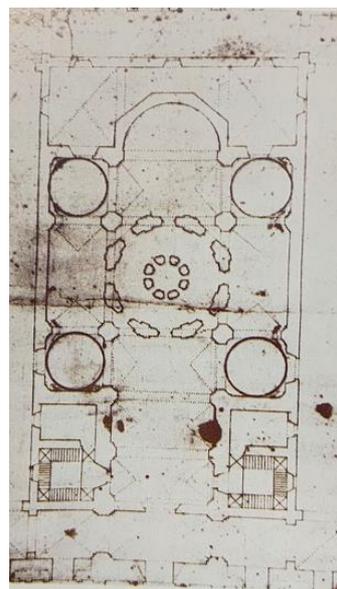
Planta de la Capilla de san Fermín, proyecto anónimo, 1759-60.
